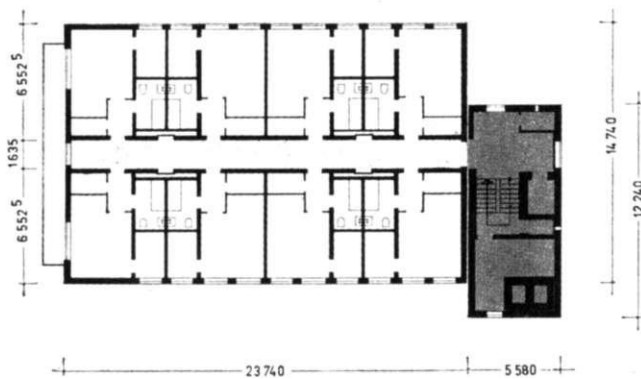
Wohnhochhaus Agnetenstraße 1963 mit Grundriß
